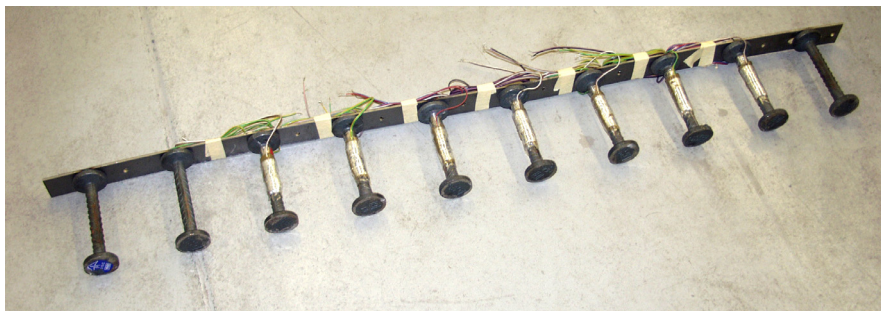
Dübelleiste mit aufgeschweißten DKA, wie sie in den Versuchen T3PSB, T3NSB und T6PSB eingebaut wurde
